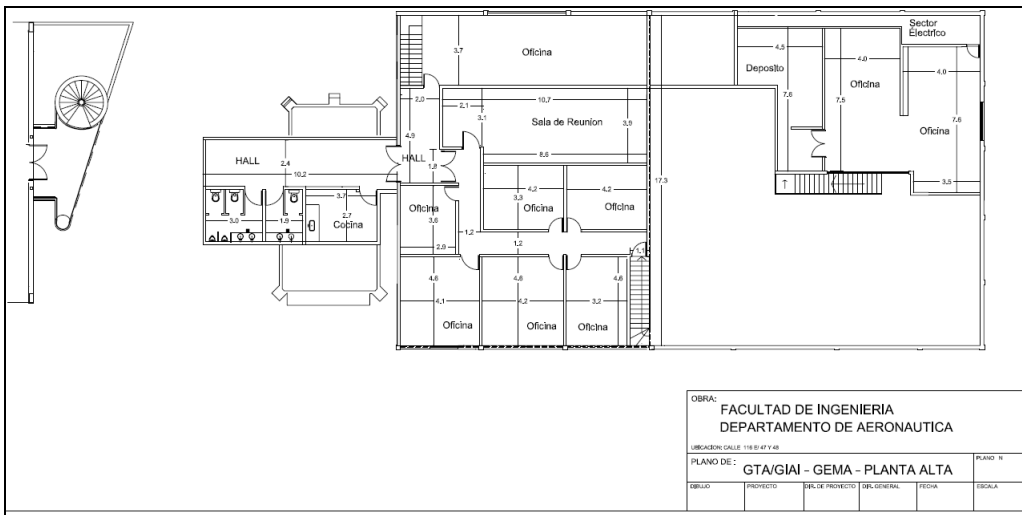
Plano de la planta alta del Edificio Laboratorios (GTA/GIAI – GEMA) y Talleres
